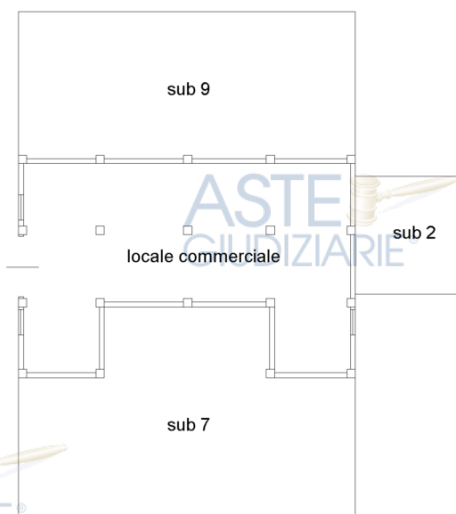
Confronto planimetria catastale e stato reale dei luoghi – piano terra
